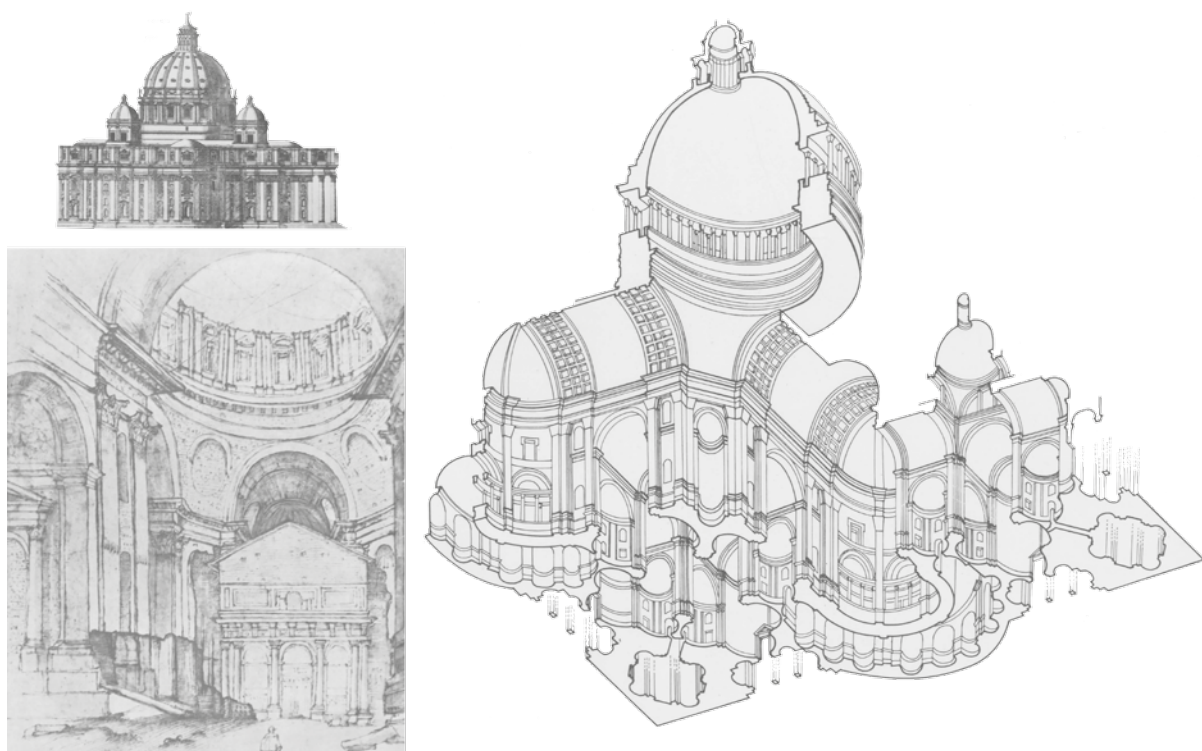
Roma, San Pietro. Prospetto, vista prospettica e assonometria.
